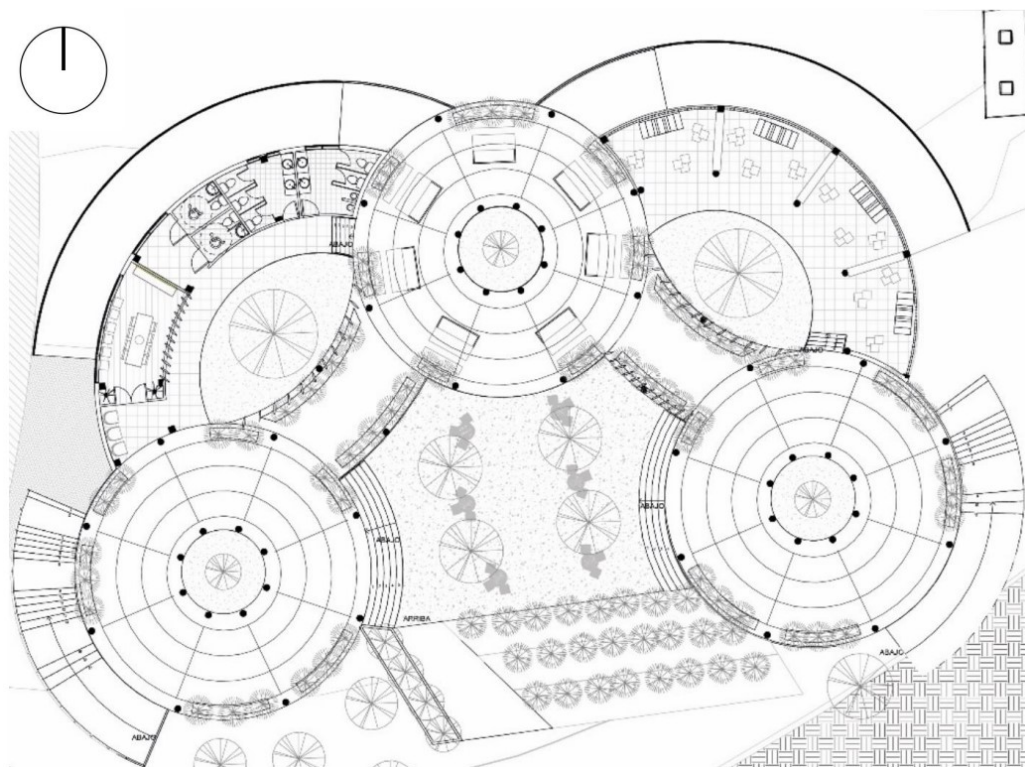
Ubicación de las columnas en planta. Fuente: Elaboración propia.
